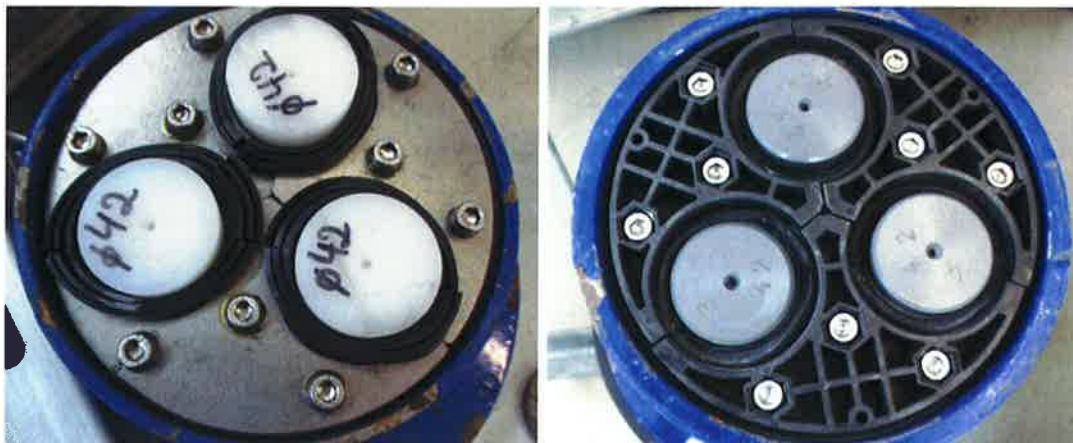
Draufsicht auf die Ringraumdichtungen (links: HRD150-SG-3/22-54; rechts: HRK150-SSG-3/24-54).
